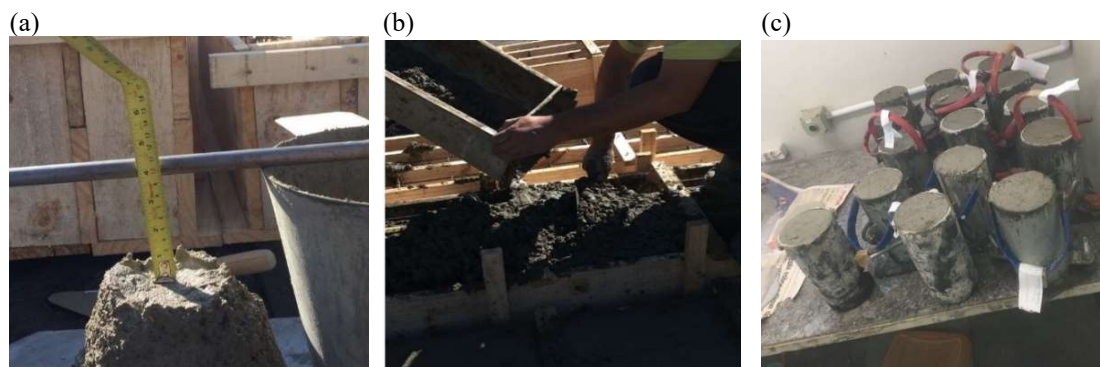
a) Ensaio de abatimento; b) Concretagem das vigas; c) Corpos-de-prova
